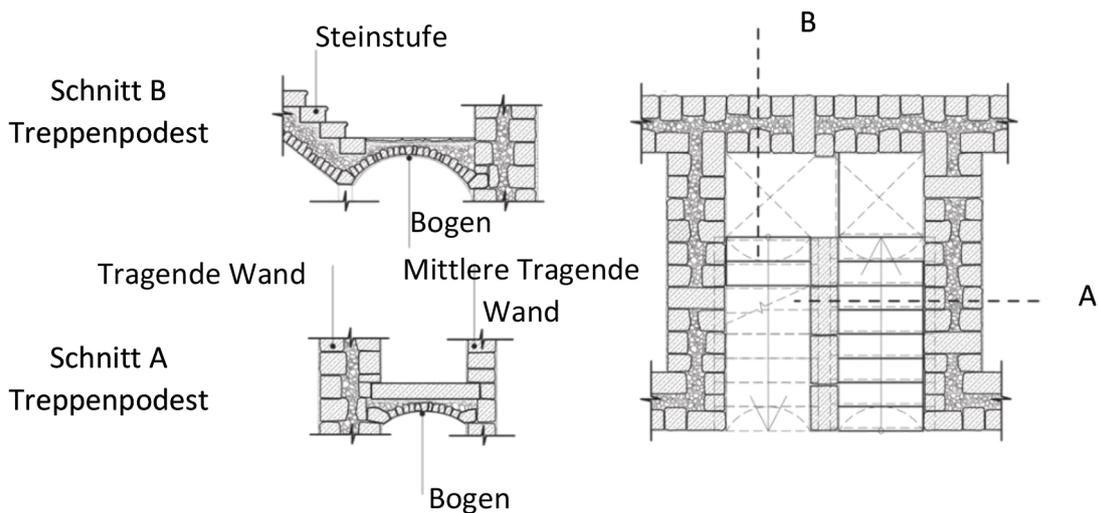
Treppen zwischen zwei Steinwänden, Bogen- Grundriss & Schnitt
